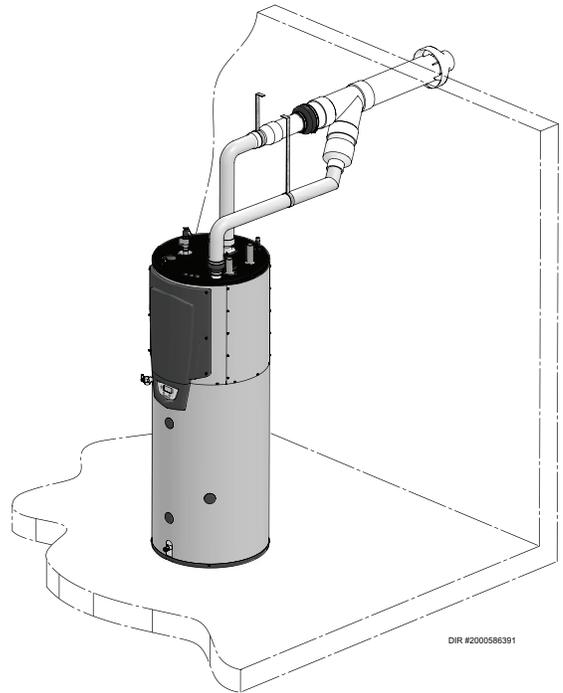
Terminaison concentrique murale en PVC/CPVC
